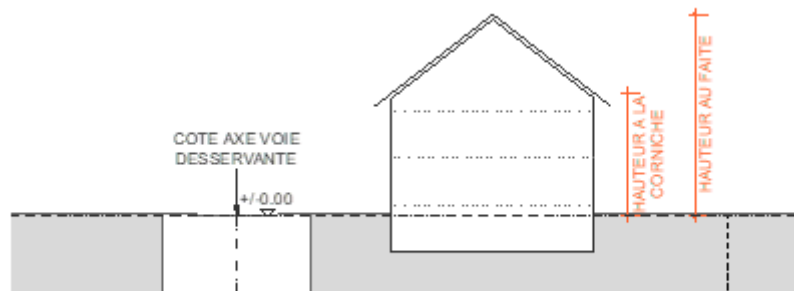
Hauteurs à la corniche et au faîte
